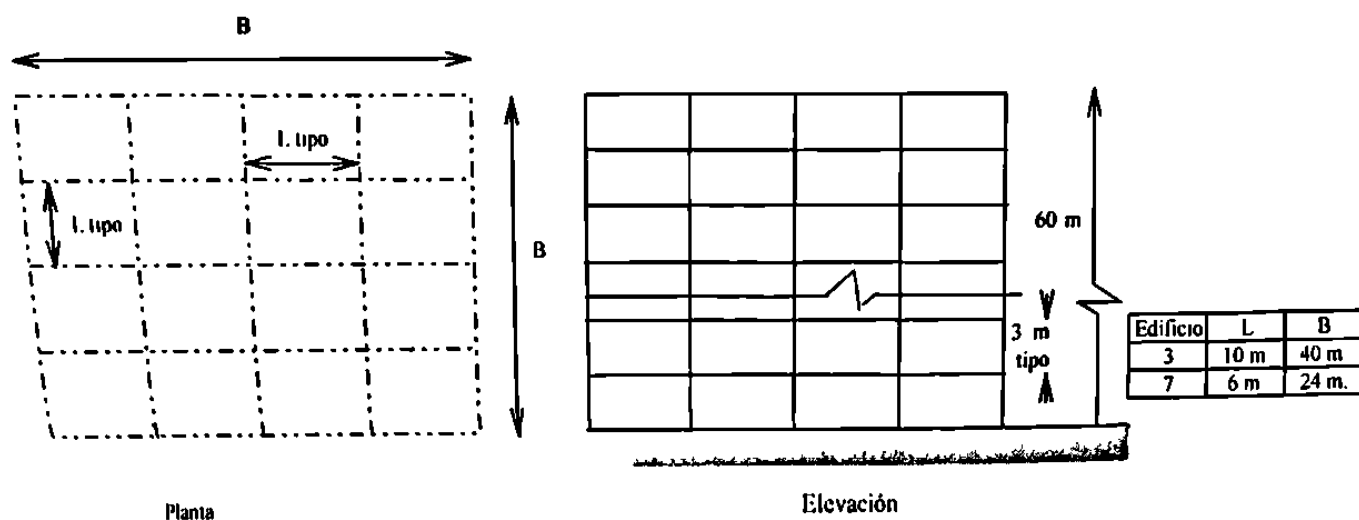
Planta y Elevación de los Edificios No. 3 y 7
